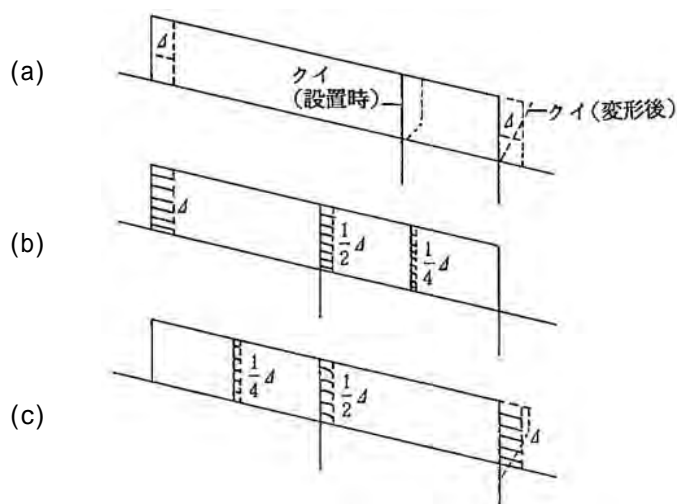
斜面の変形と杭の設置位置（直線すべり面の場合）
